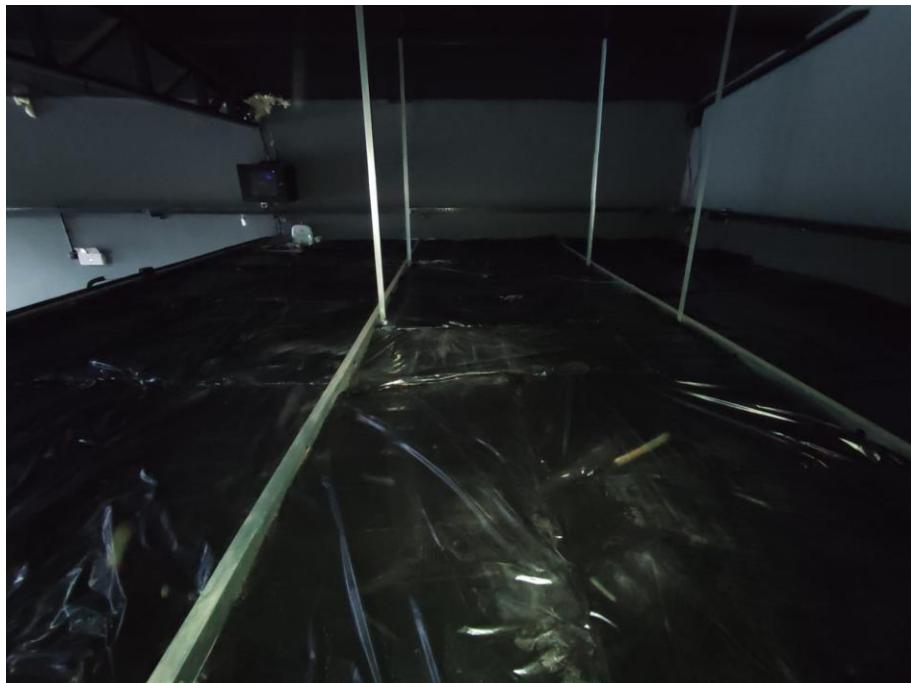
instalação do lona acima do painel de la de rocha. (autor)
